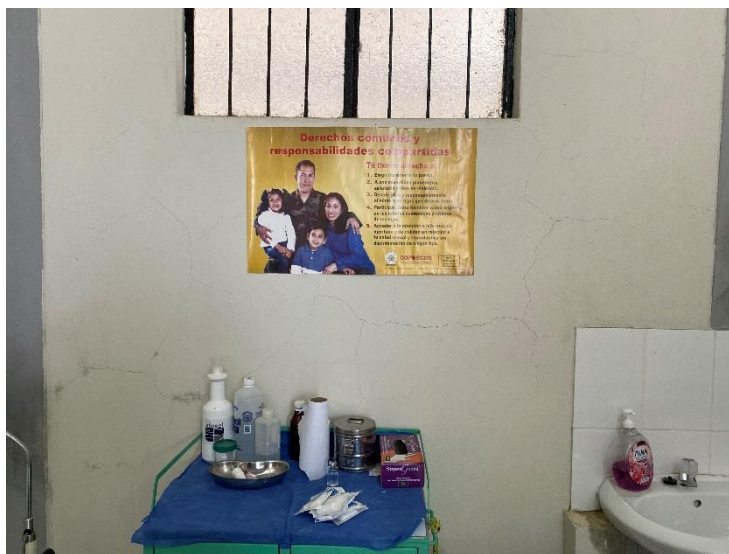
Grietas conjugadas en centro de salud del anexo de Isla San Lorenzo.
